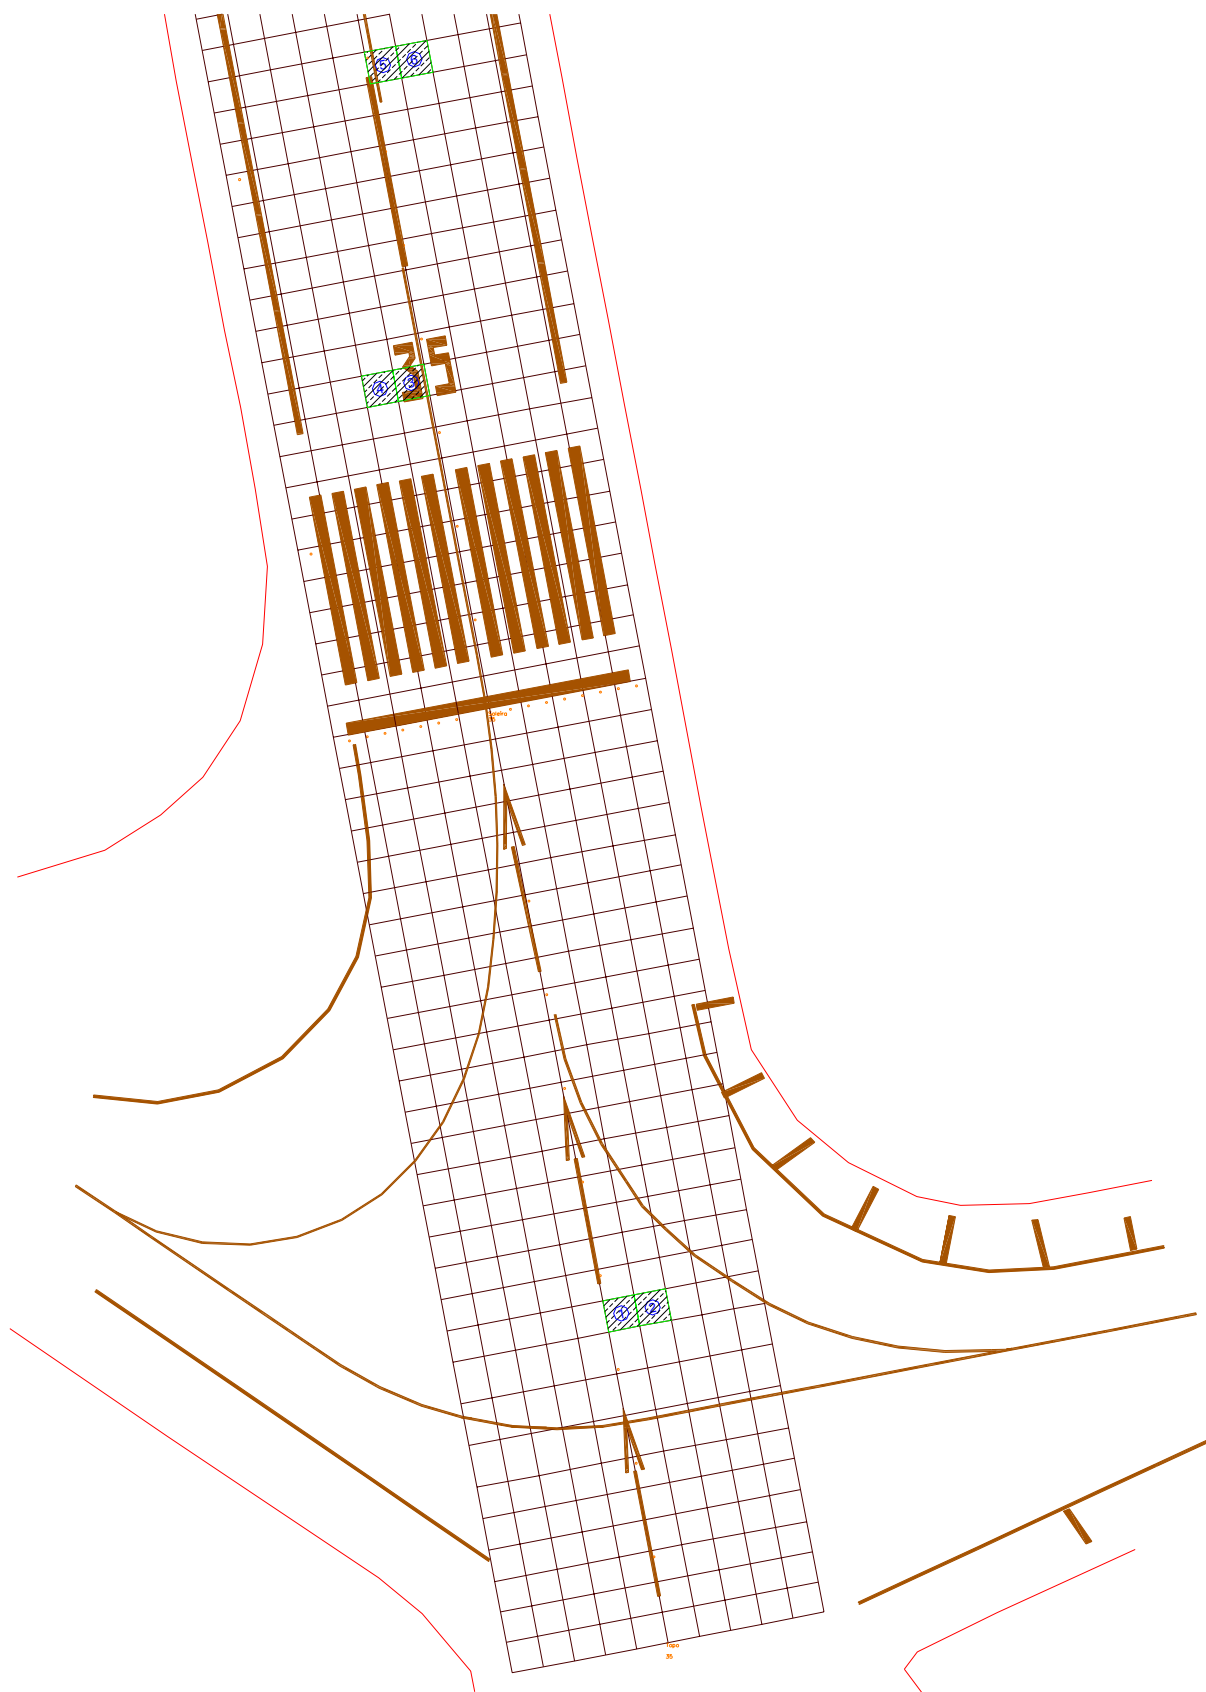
Localização das lajes ensaiadas da pista 17-35
